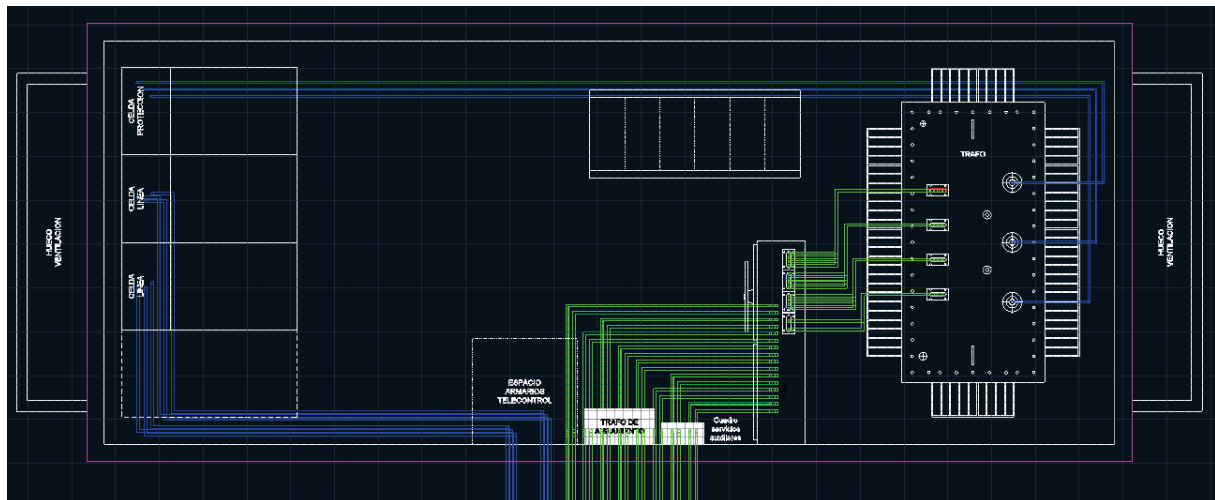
Vista en planta de la instalación (2L+1T [Sub]) (cotas en mm).
